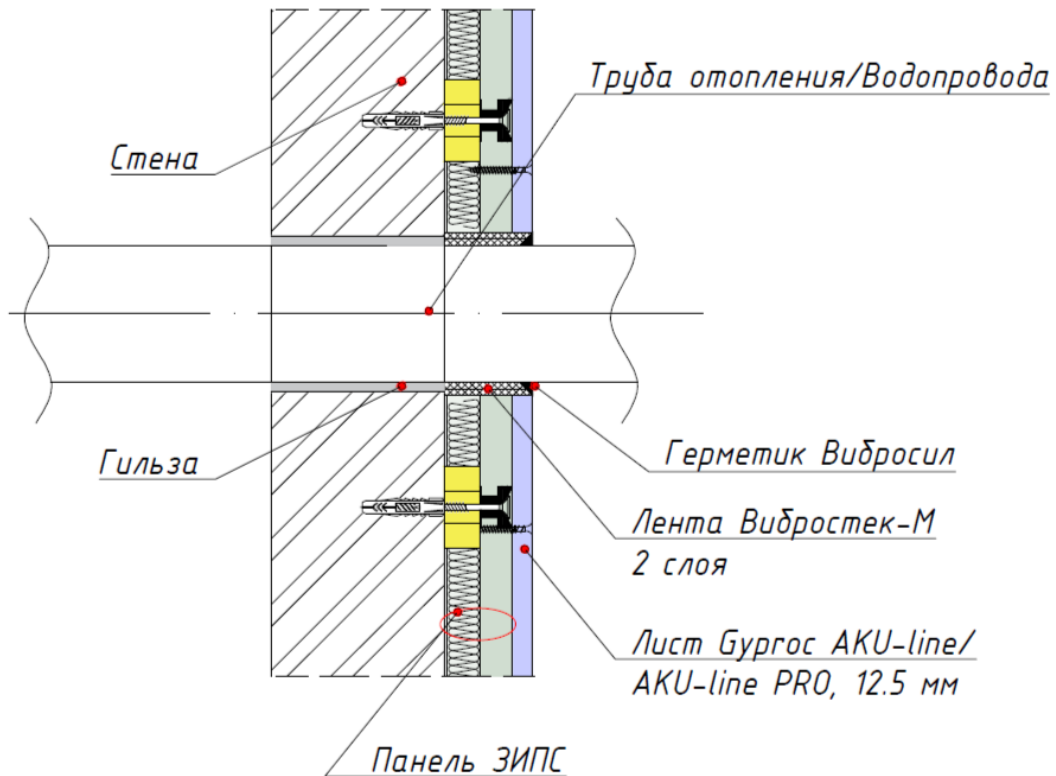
Схема пропуска труб отопления/водопровода через конструкцию звукоизоляционной бескаркасной системы ЗИПС.
